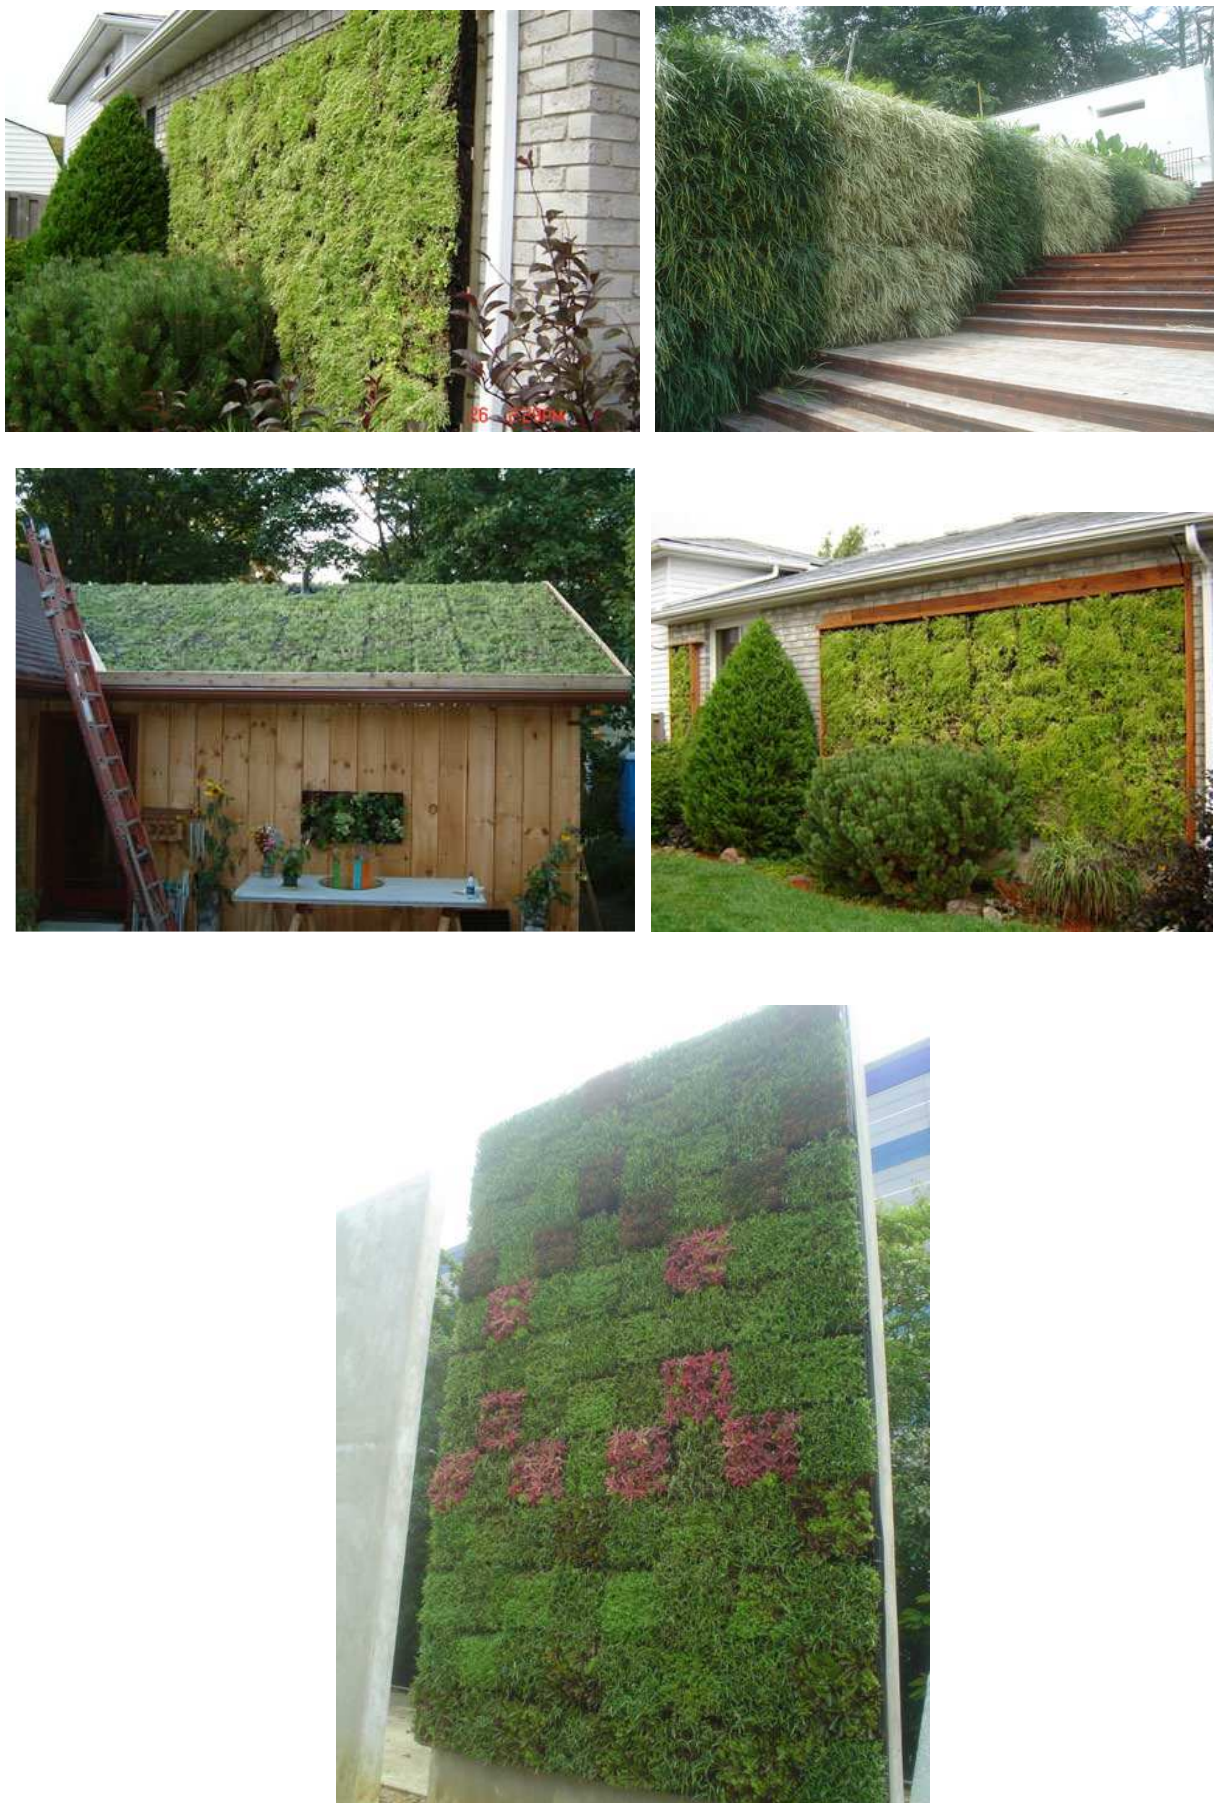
ELT Easy Green Living Wall Panel. Exemples
